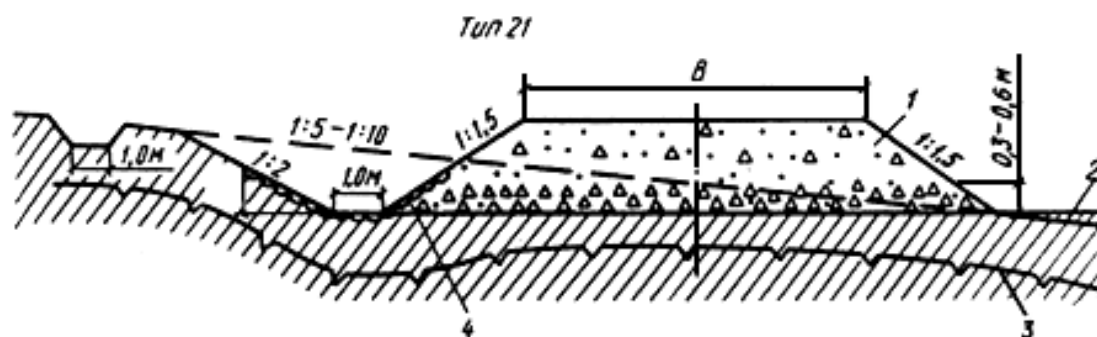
Поперечный профиль насыпи на неустойчивом склоне:
